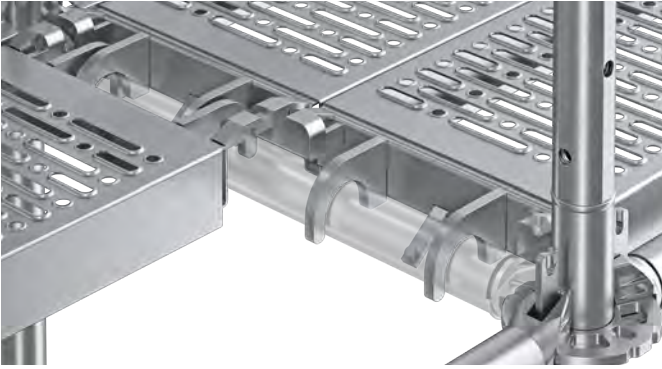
Alternativ: Aufbau mit Rundrohrriegel und Stahlböden mit integrierter Abhebesicherung
